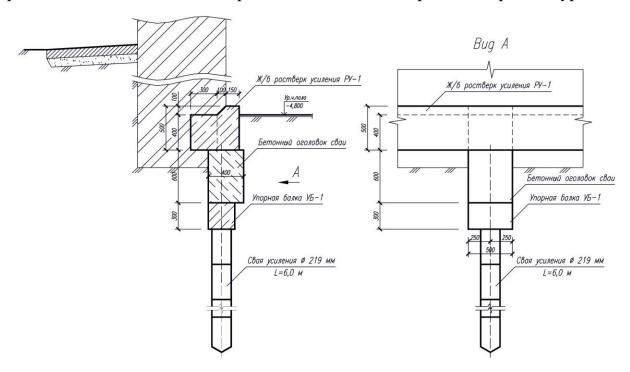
Схема усиления фундаментов наружных стен многосекционными трубобетонными сваями
